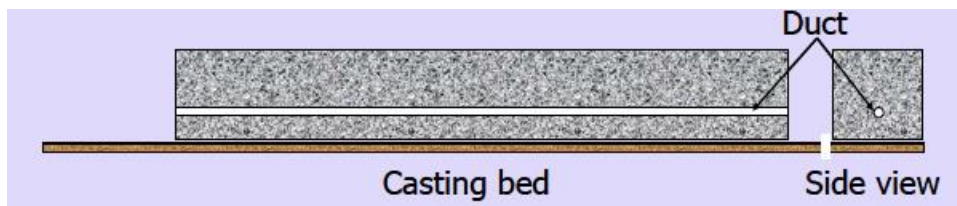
Betonagem do elemento (Sengupta & Menon, n.d.).
